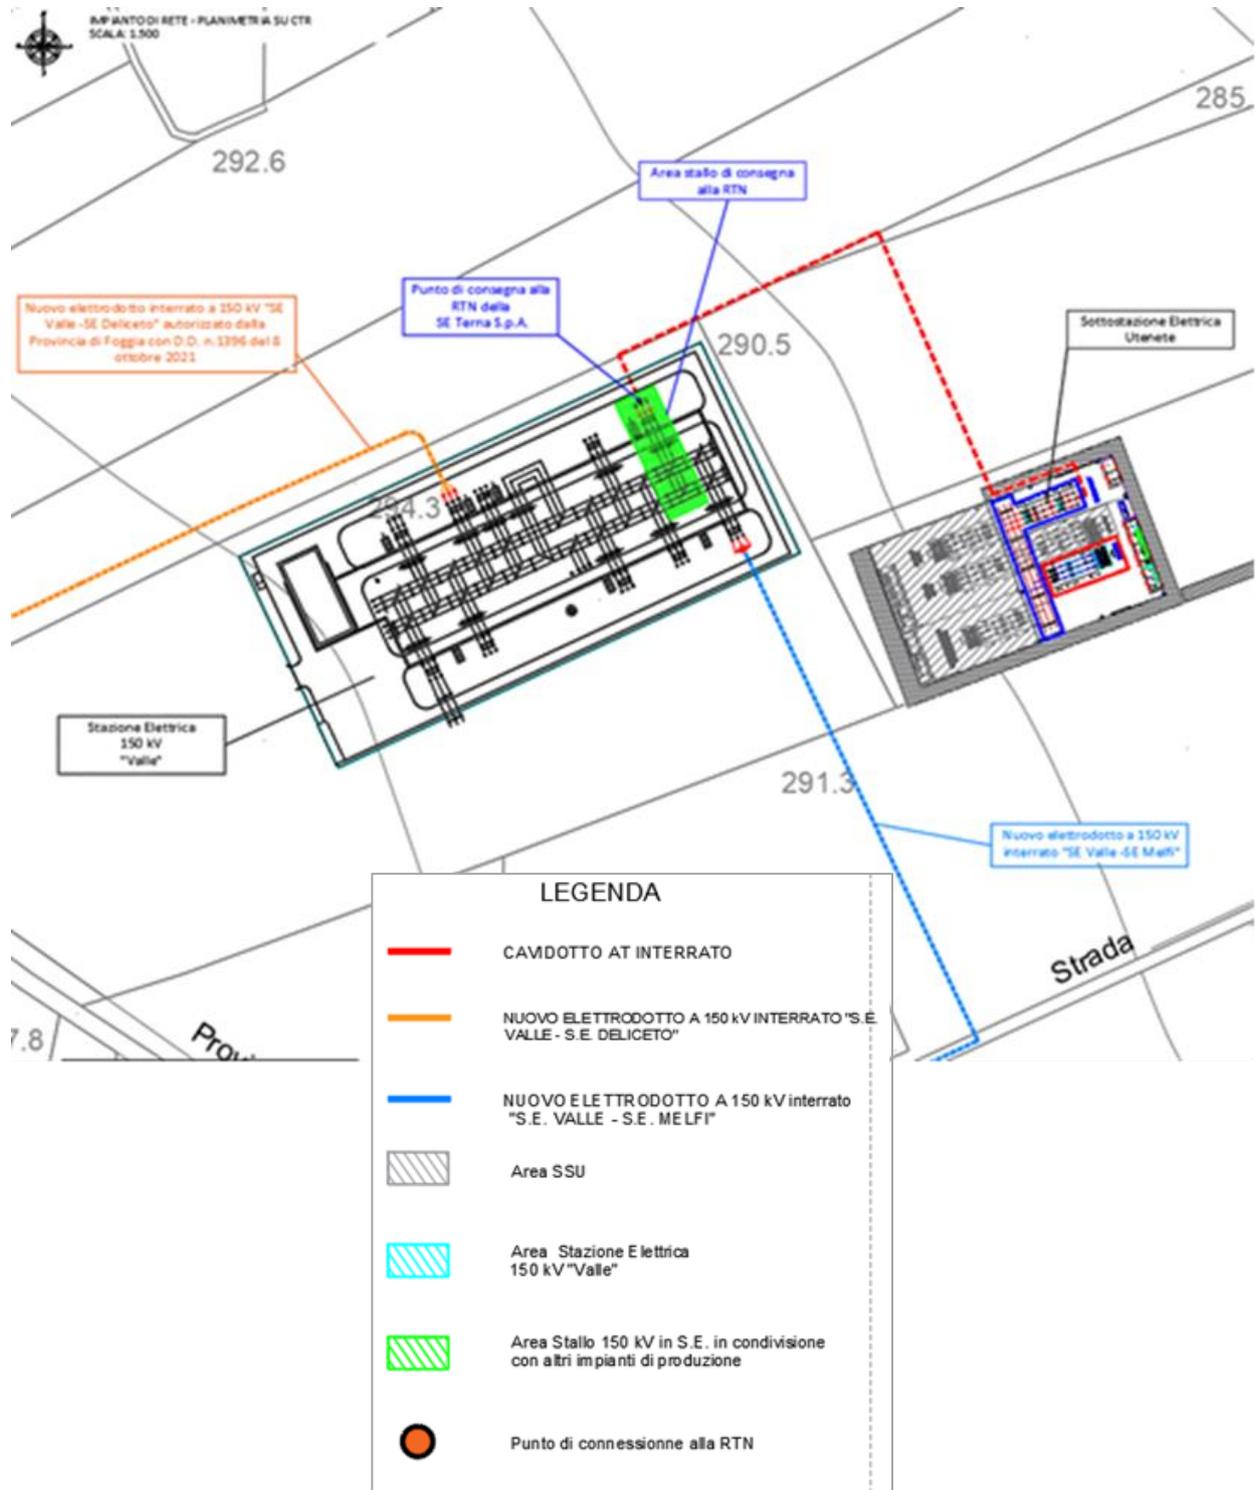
Stralcio dell'inquadramento delle infrastrutture di rete
